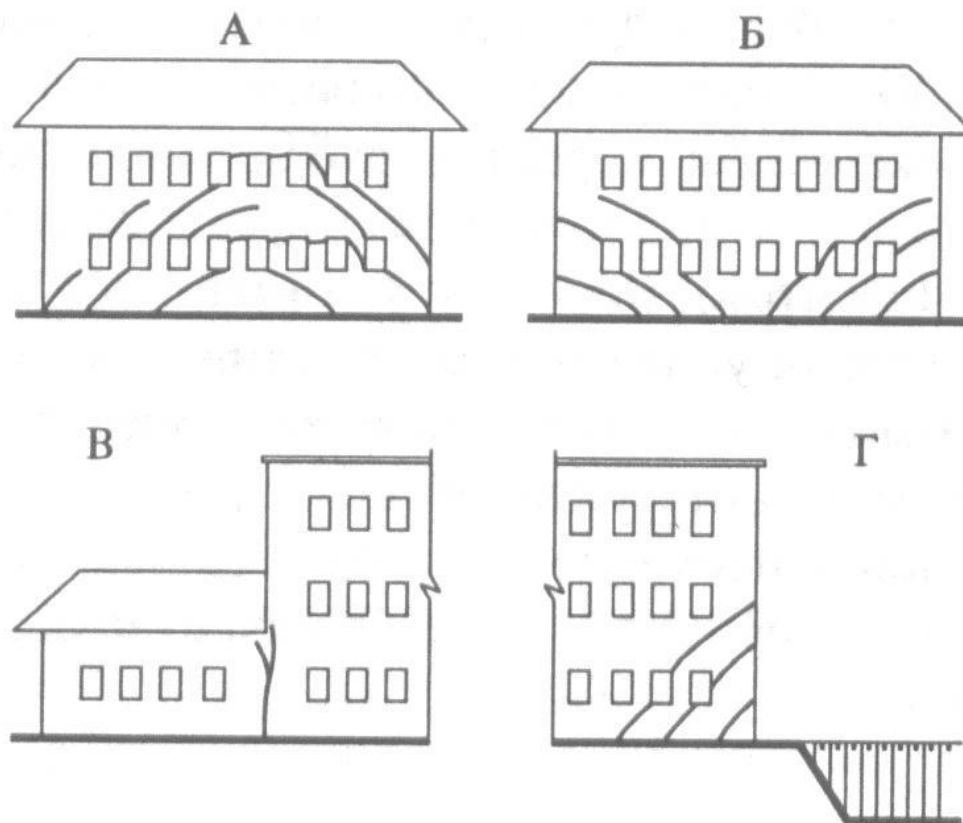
Характер трещин в наружных несущих стенах здания вследствие неудовлетворительного состояния оснований и фундаментов:
